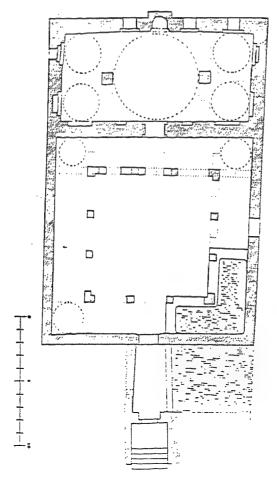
زبيد، مسجد ومدرسة الدويدار، المسقط الأفقى (عن ТЕНАМАН)
